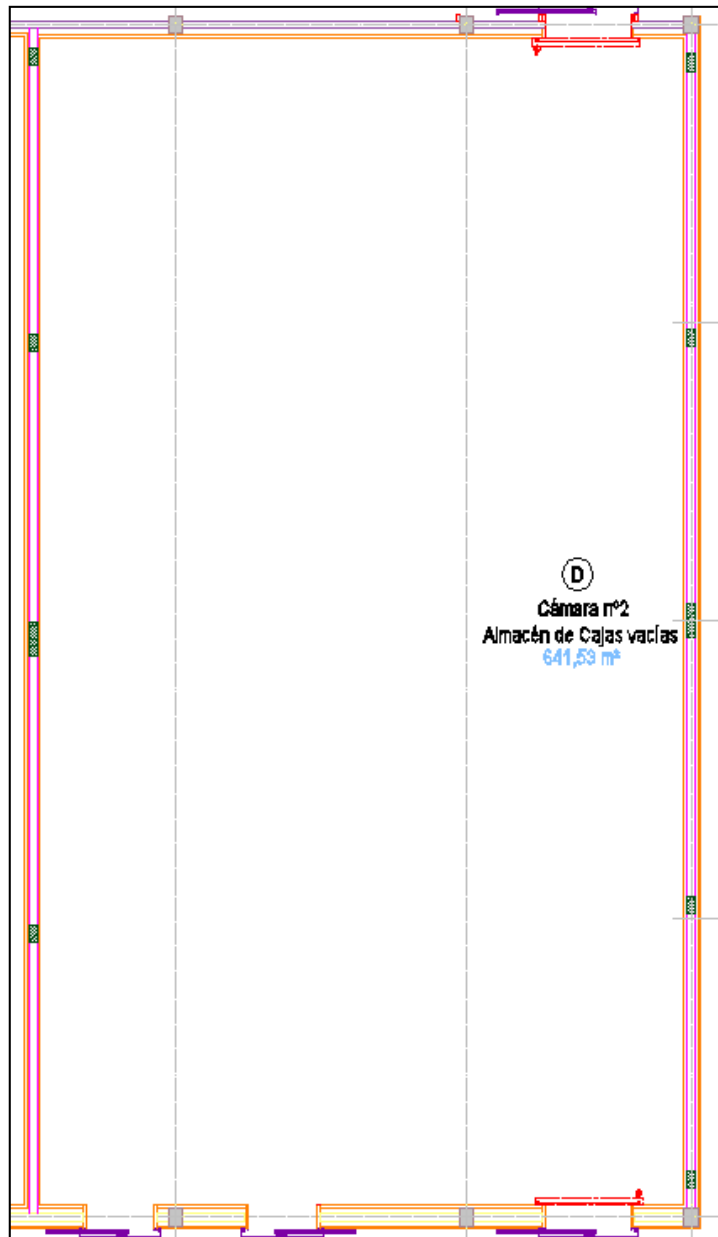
Plano de la cámara estudio. (Elaboración propia).
